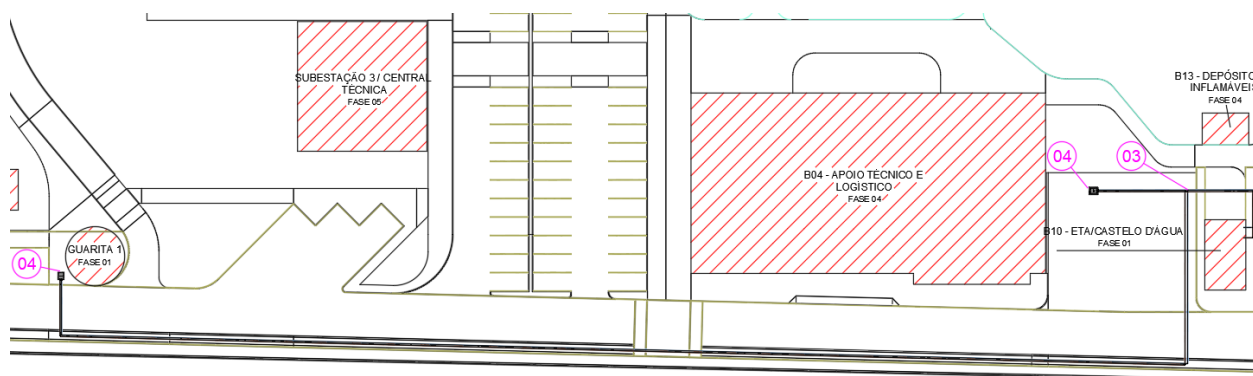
Planta trecho (Castelo d'água / Bloco B04 – Guarita 01)
